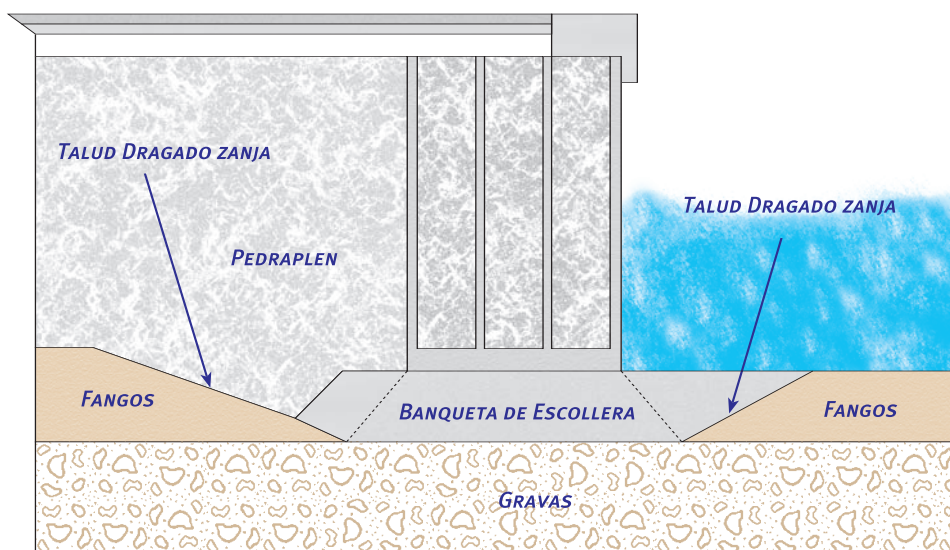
Sección tipo de muelle cimentado en un terreno con un estrato blando superficial.
